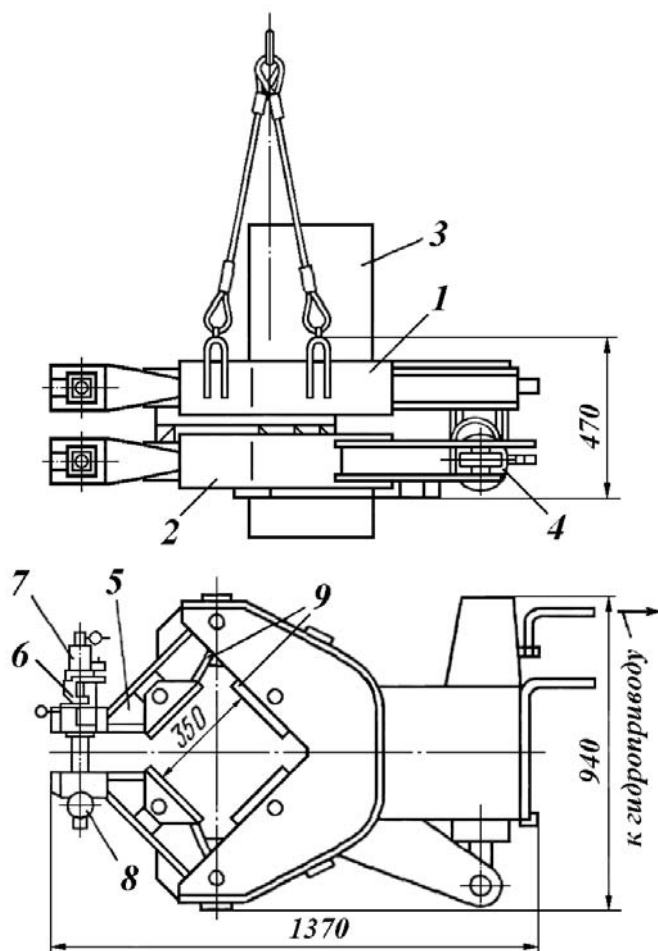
Схема устройства для скручивания железобетонных свай
